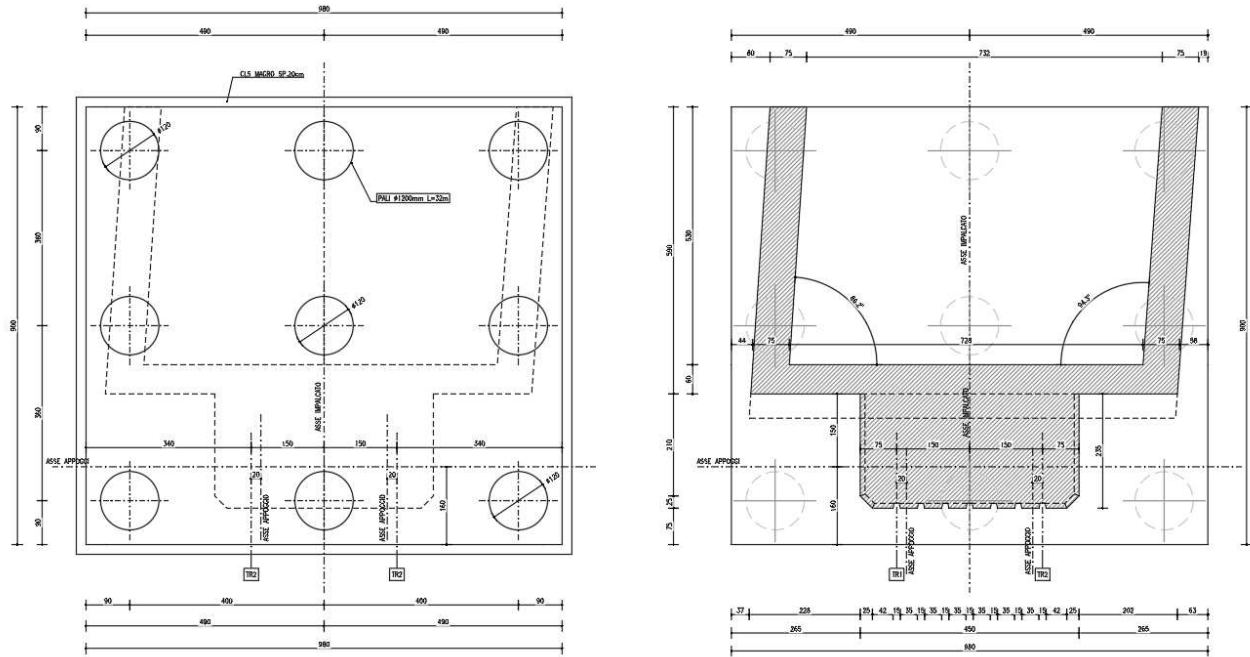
Spalla 1 – carpenteria fondazioni
